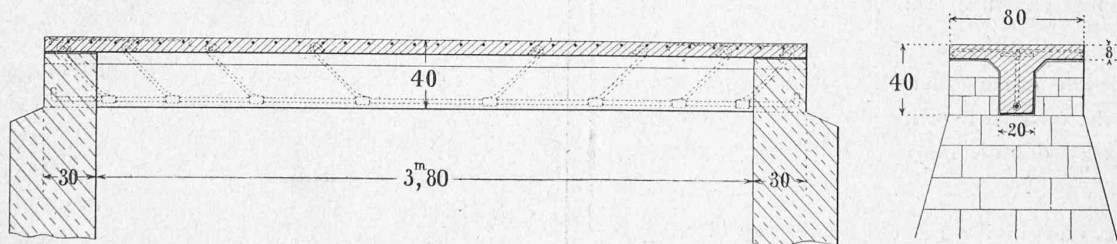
Poutre en béton armé système Lossier (N° 1). Armature: 1 barre ronde de 30 mm. — Echelle: 1 : 40.
